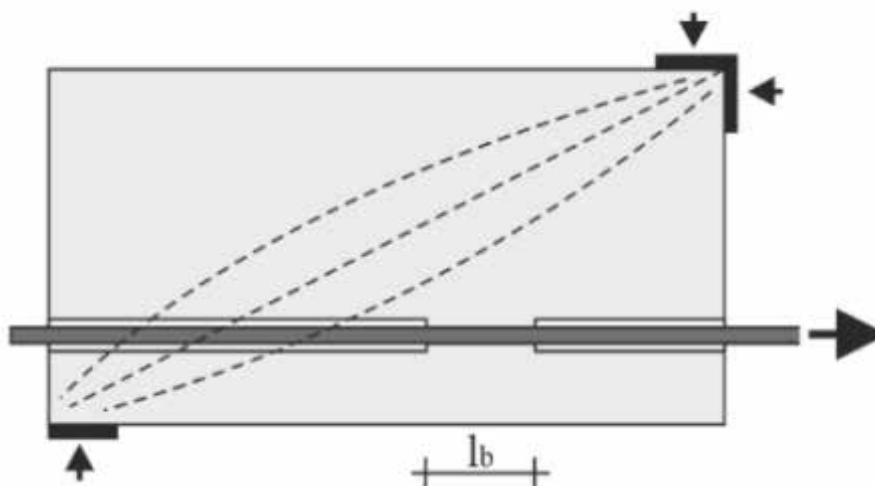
Схема випробування зчеплення арматури з бетоном по методиці ASTM A944-10
